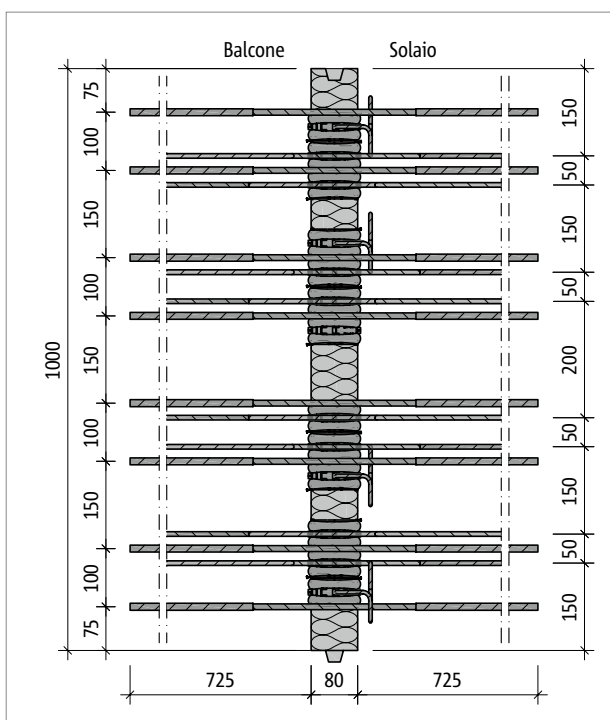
Schöck Isokorb® T tipo K-M6-VV1: pianta del prodotto
